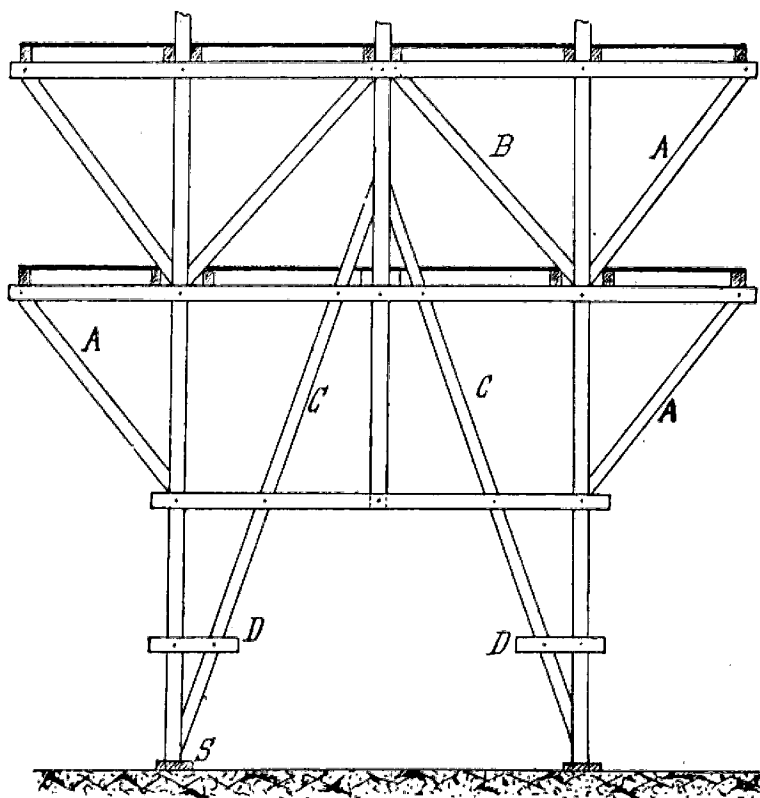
Dispositif d'échafaudage avec porte-à-faux et poteau additionnel.
